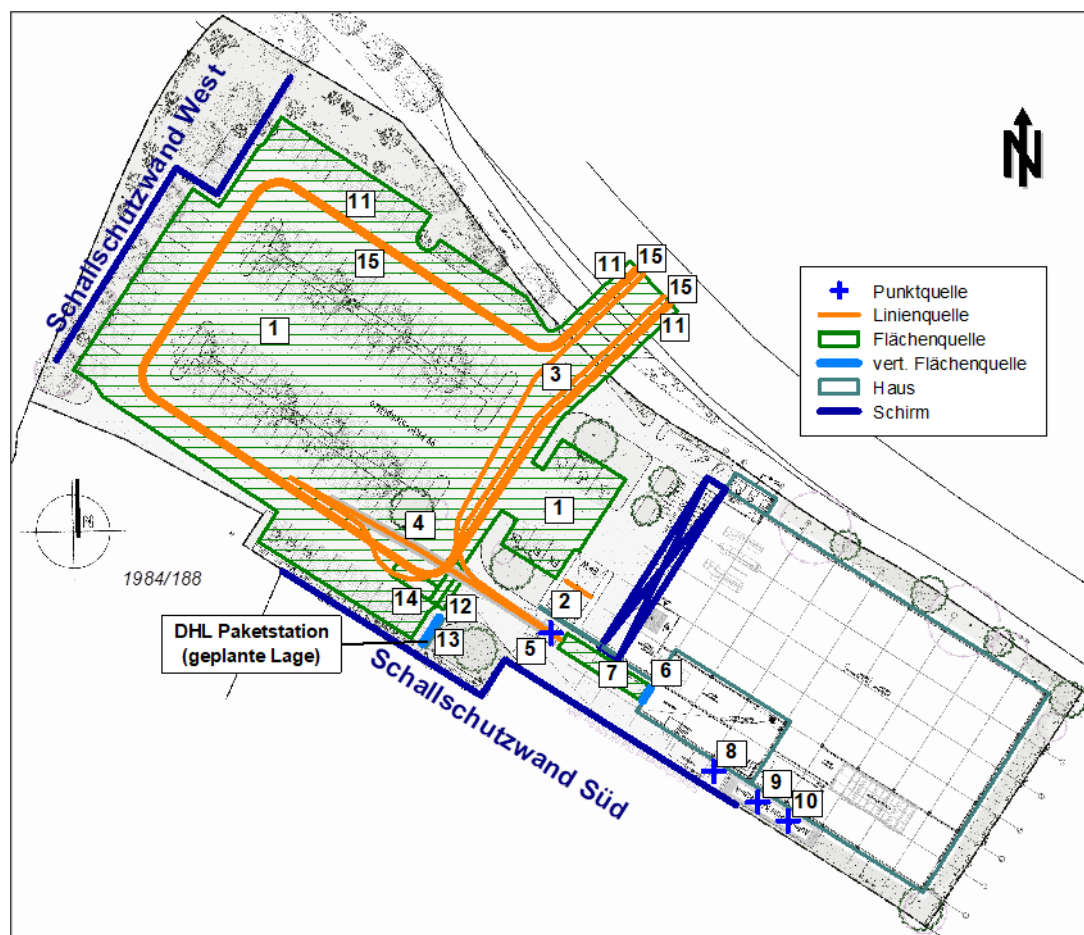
Entwurf Grundriss mit Außenanlagen [6] und Ergänzung der Lage der Schallquellen.
